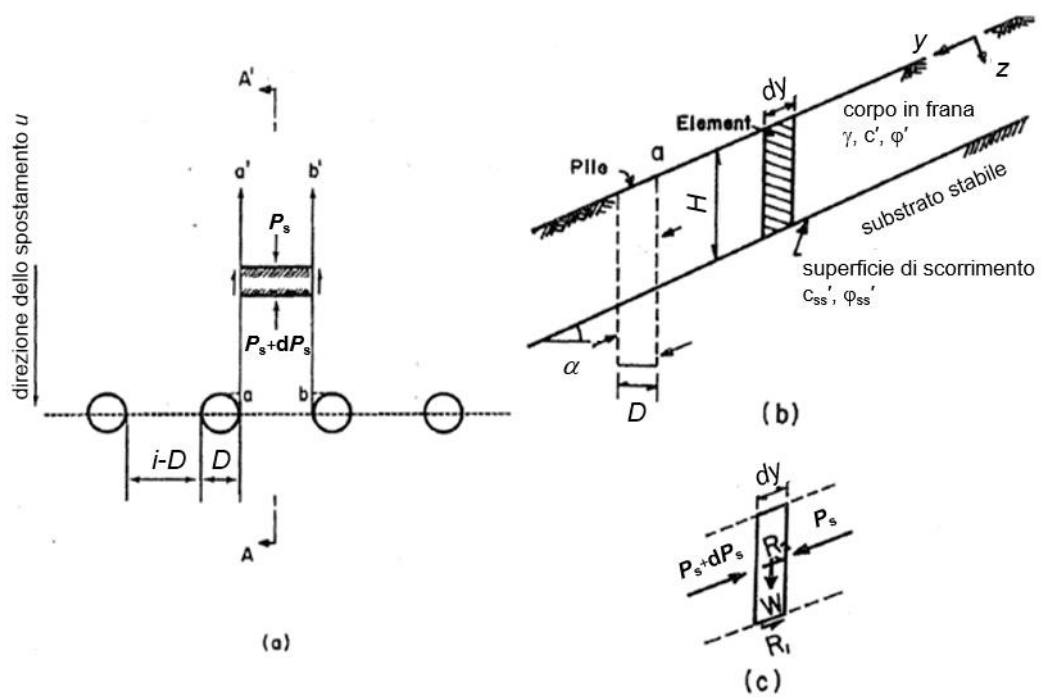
Schema di riferimento per lo studio di stabilizzazione di un pendio con pali: (a) vista in pianta; (b) sezione longitudinale; (c) generico elemento (adattata da Wang e Yen, 1974).
